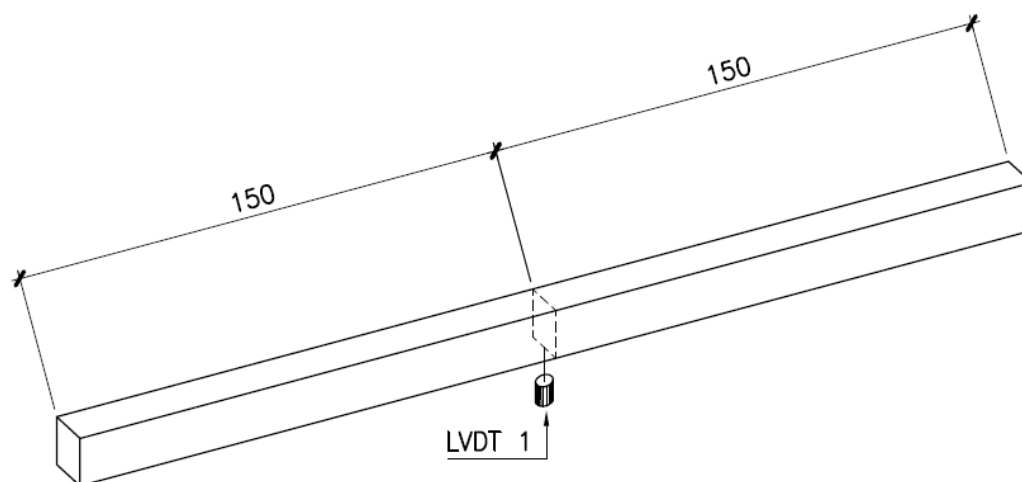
Posição do transdutor linear de deslocamento (dimensões em cm).
